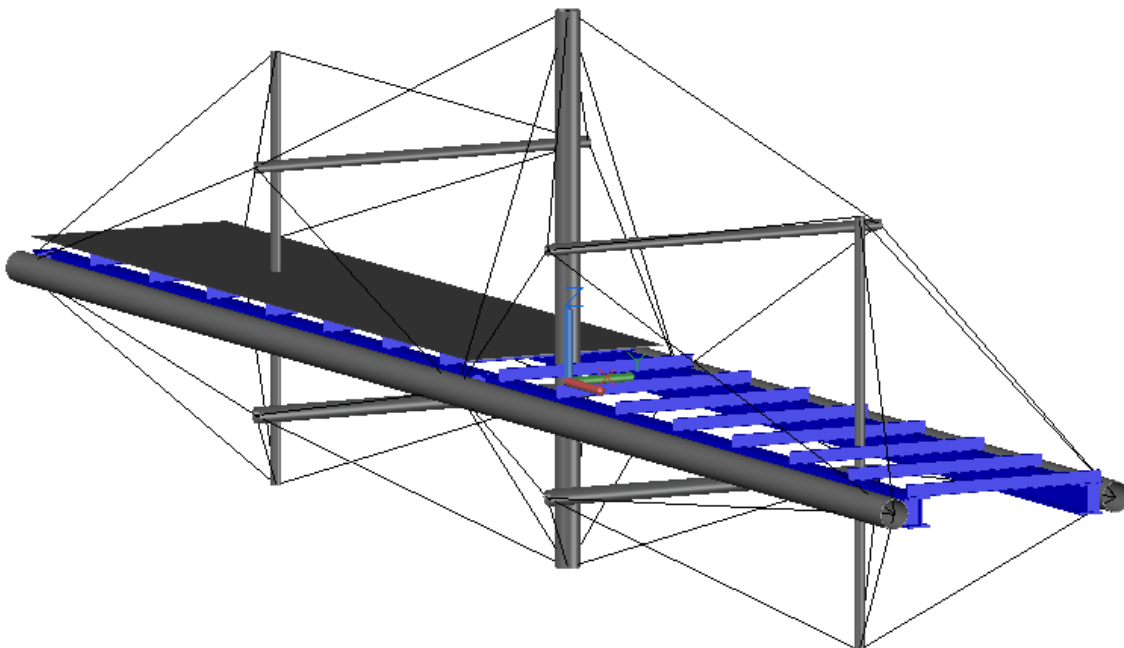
Modelo del puente realizado en AutoCAD donde se puede apreciar las vigas que sostienen al tablero. Estas vigas se unen a los elementos del puente tensegrítico únicamente en los extremos de los elementos del grupo de simetría 5.
